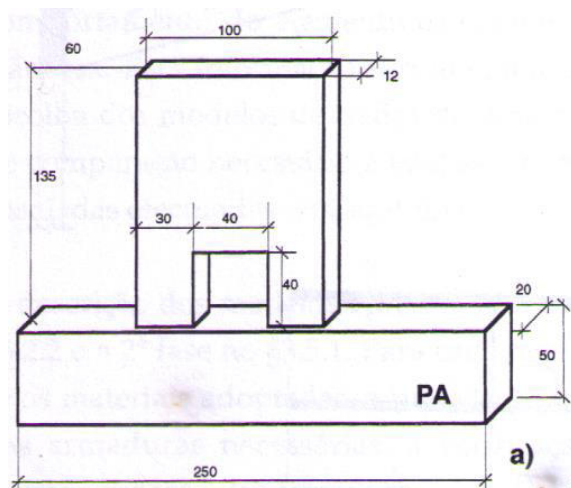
Geometria das paredes dos ensaios (dimensões em mm) [8]
